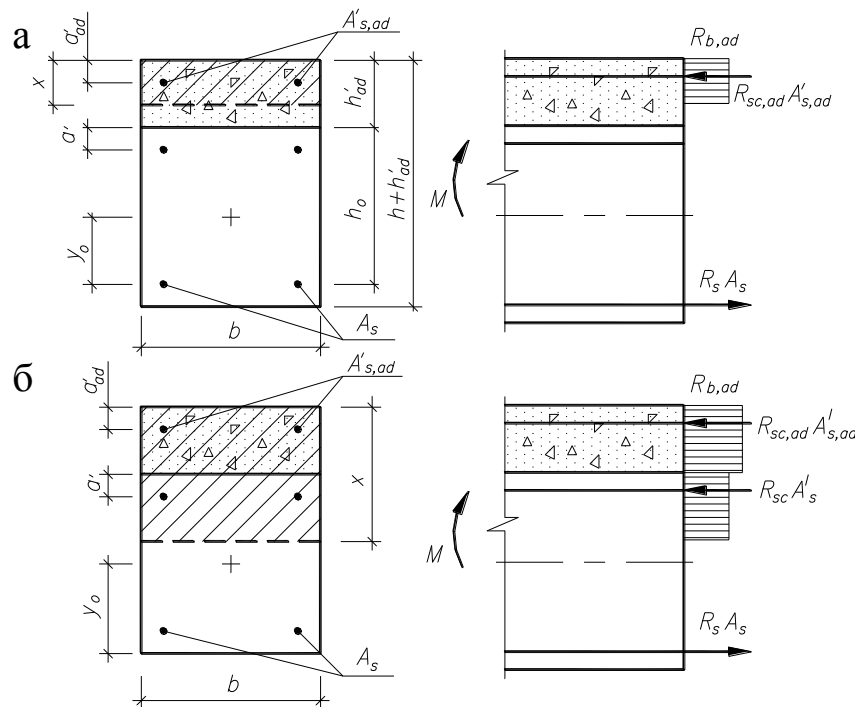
Схемы усилий и эпюры напряжений в нормальном сечении усиленного наращиванием элемента при условии $\xi \leq \xi_R$:
